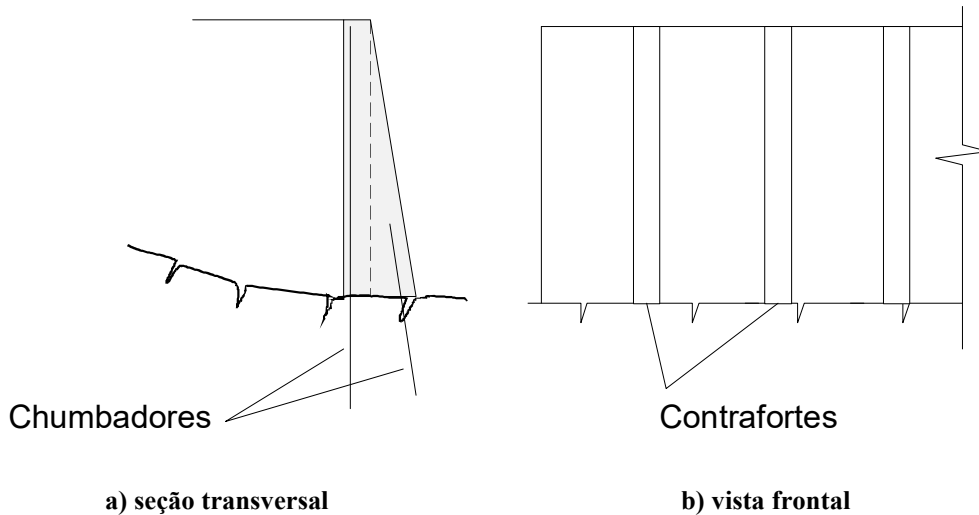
Muro de concreto ancorado na base: seção transversal
